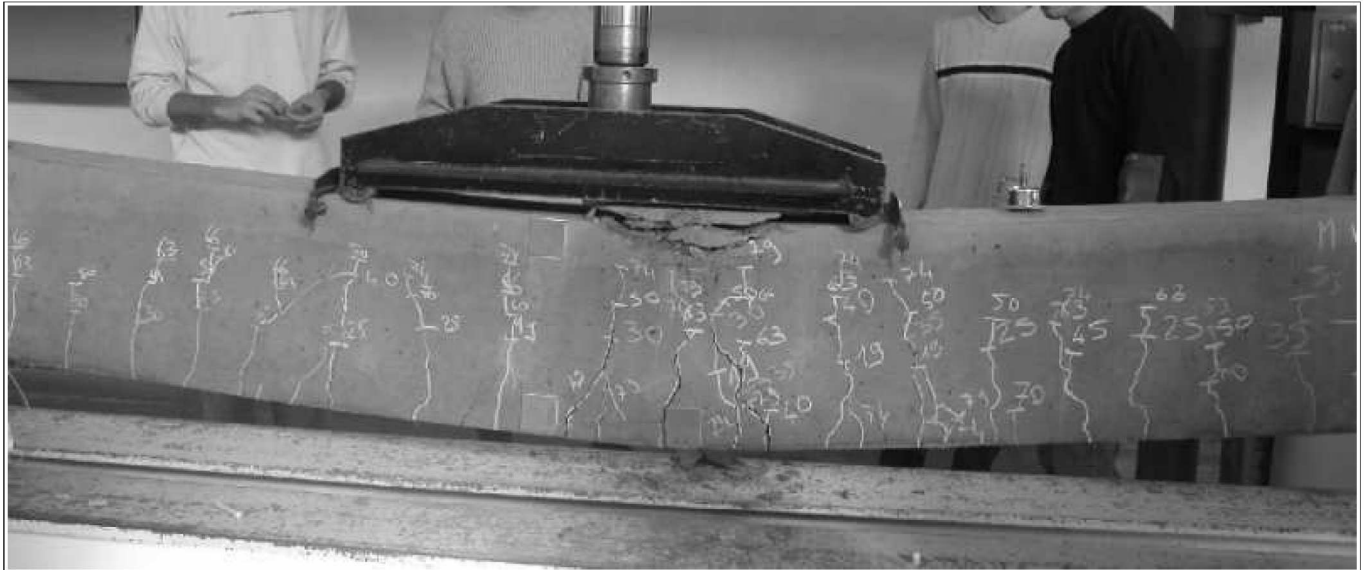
développement des fissures dans la zone tendue d'une poutre fléchie
